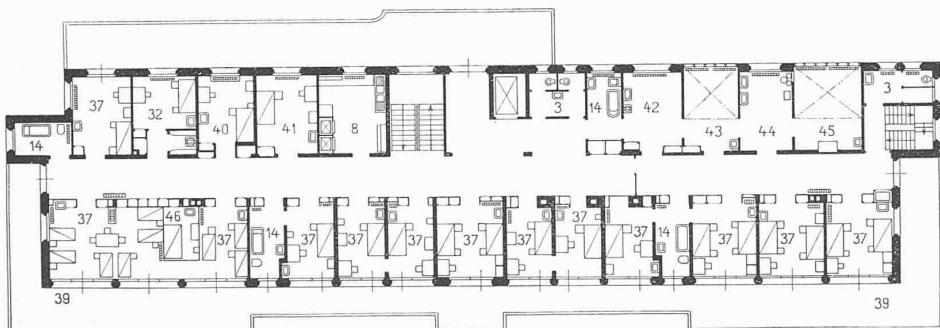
Grundriss vom I. Stock. — Masstab 1 : 400.
